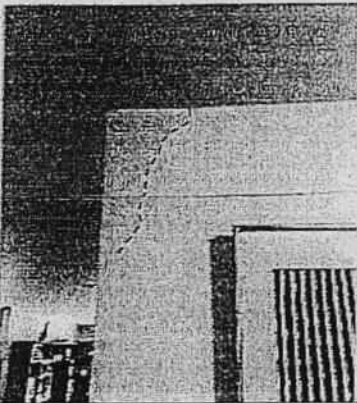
y 16. Fisuras en muro de antepecho apartamento 202 torre costado sur.
